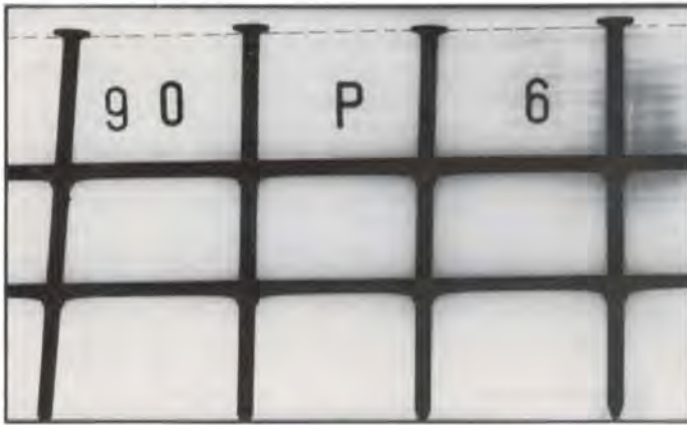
Probekörper aus BSH mit 2 Blechen ($t = 2,0$ mm), genagelt mit Nägeln 36×90 und einem Druck von $6,0$ bar (--- = Holzkante).
